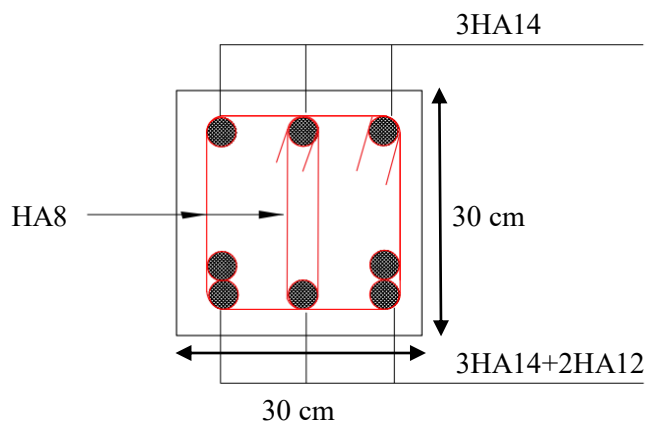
Ferrailage des poutres secondaires en travée 30x30
